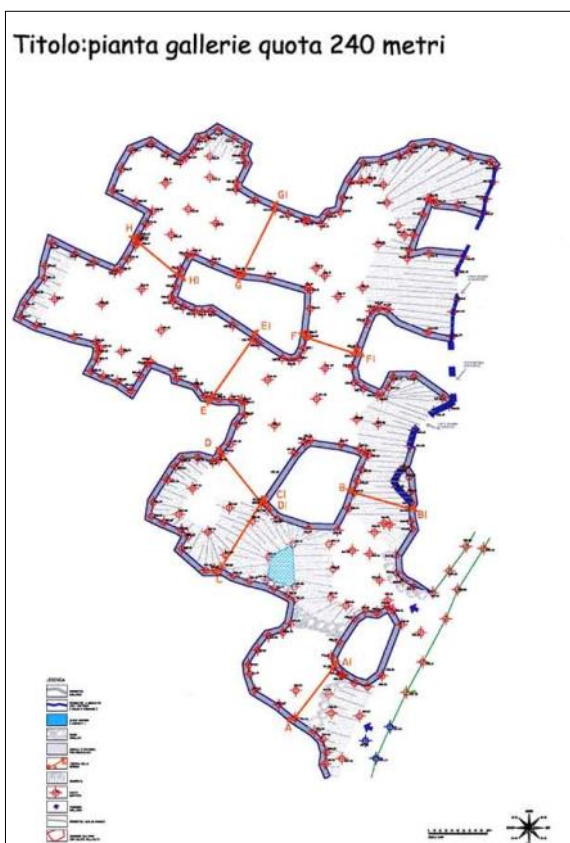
Pianta della coltivazione a 240 m s.l.m. (F.lli Frignani).
